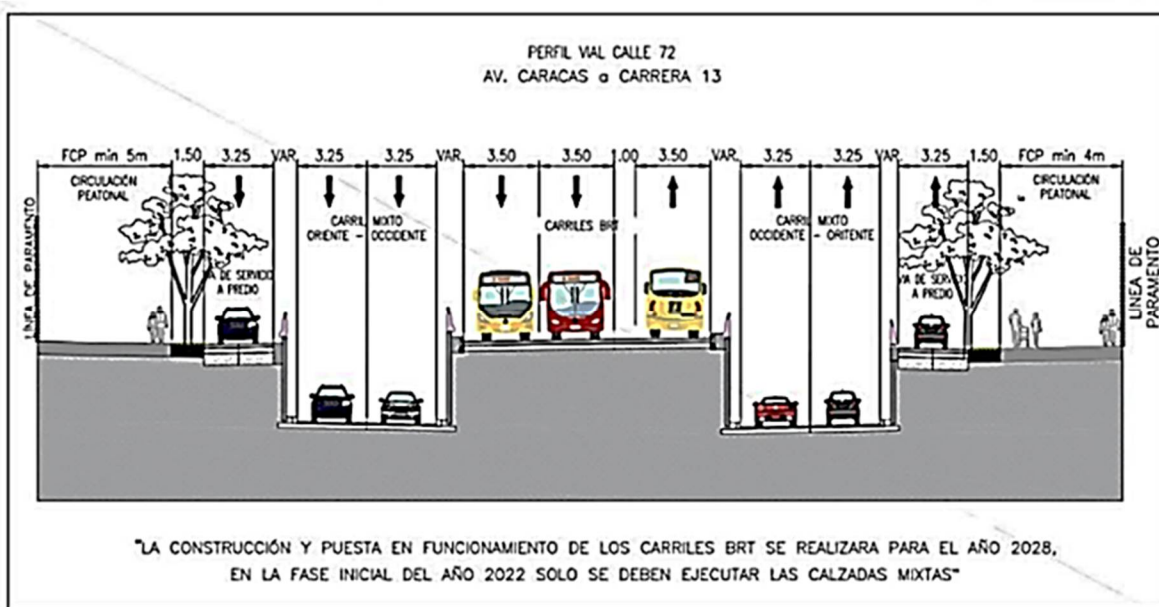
Sección típica vial calle 72 – Oriente de Av. Caracas
